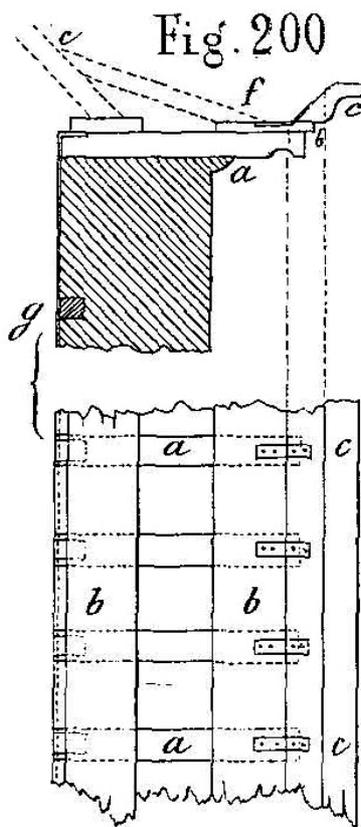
Cornisa de madera (Rebolledo 1876, lám.9).
